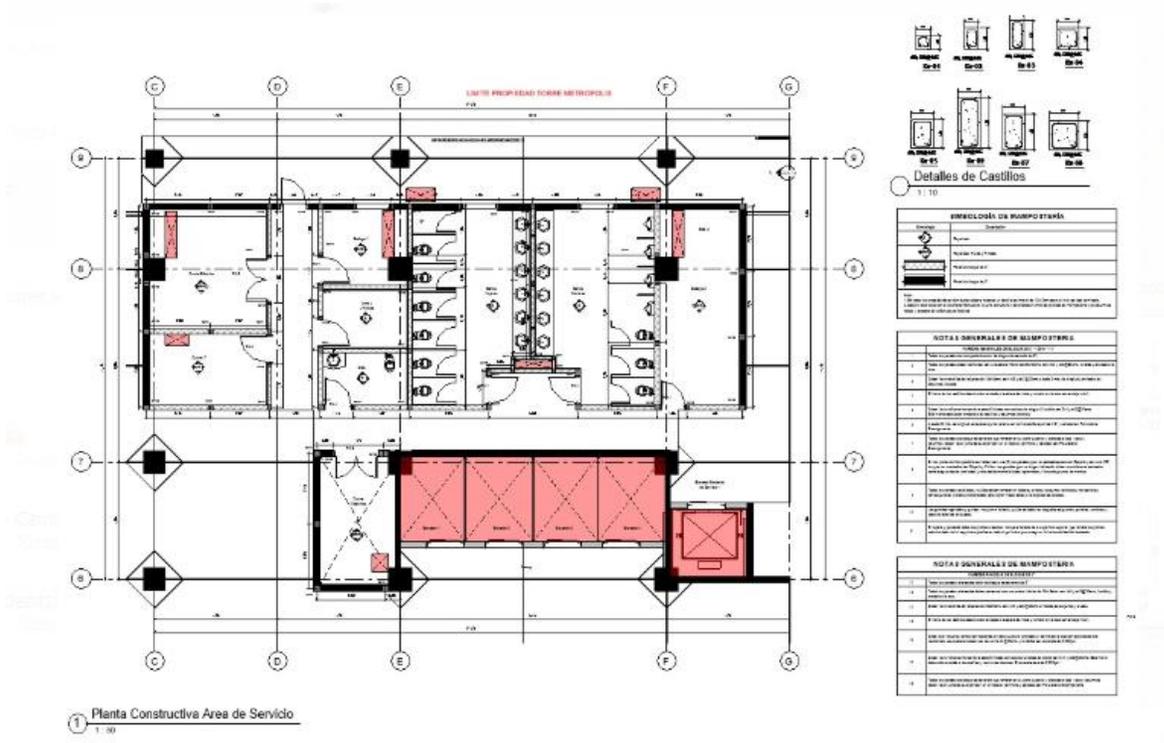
Planta Constructiva de Baños y Áreas de Servicio proyecto BAC
